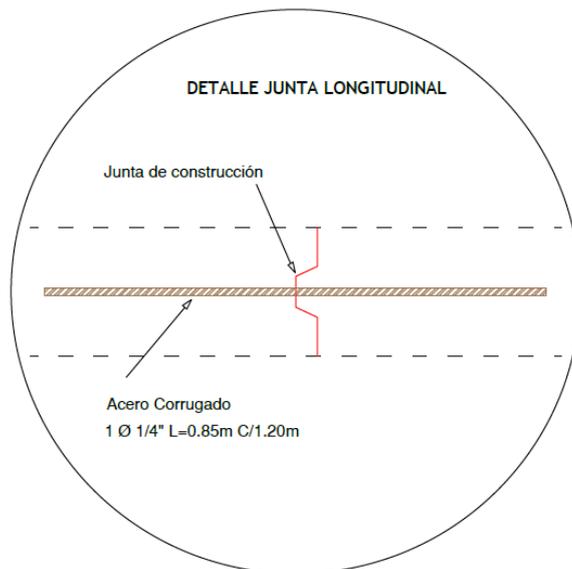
Detalle de la junta longitudinal. Elaboración Propia
